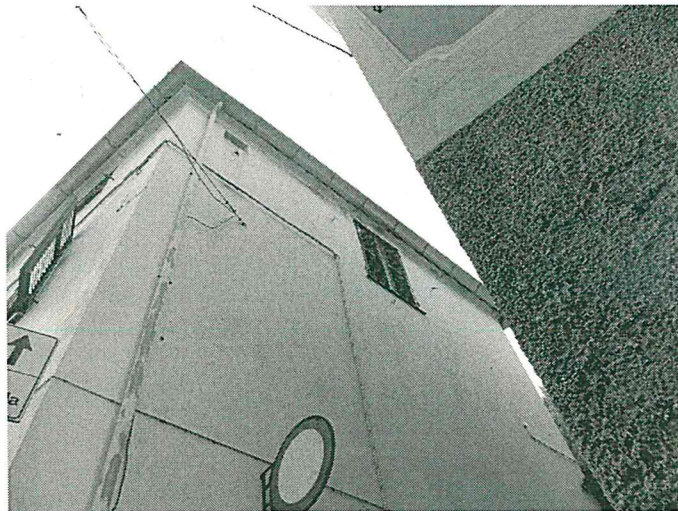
Prospetto su Viottolo Nicolò Ardizzone (ovest)
